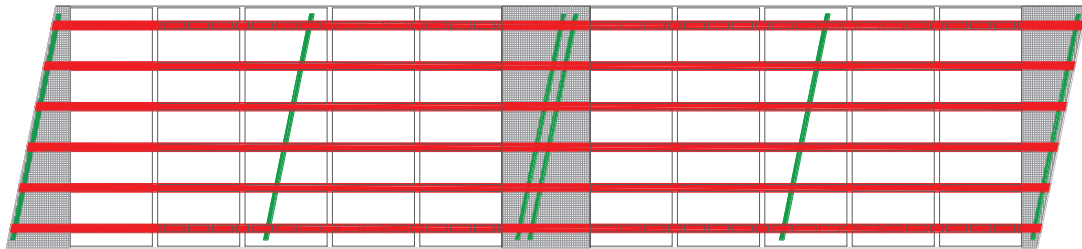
Vista esquemática de la planta del puente de calle Paso.
